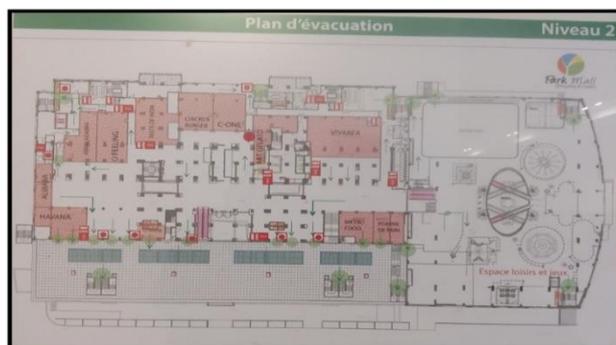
plan 2<sup>ème</sup> étage de centre
